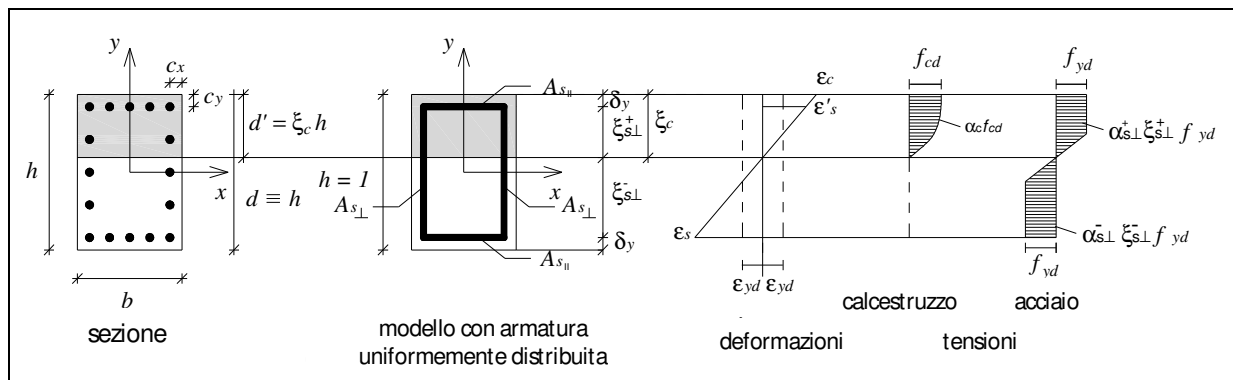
Quantità adimensionali che descrivono la geometria e lo stato deformativo e tensionale (sia nel calcestruzzo che nell'acciaio) di una sezione rettangolare in c.a. con armatura doppia simmetrica.
